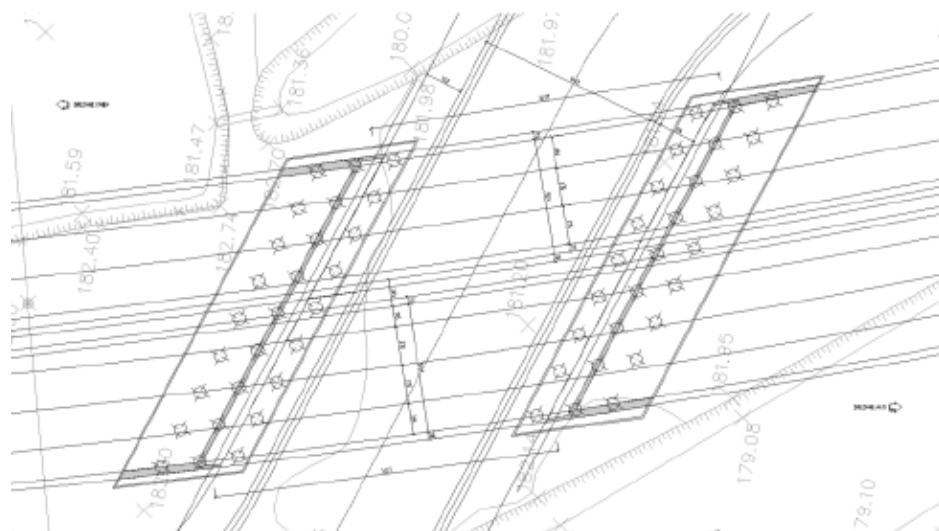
Attraversamento Canale ENEL vista planimetrica
